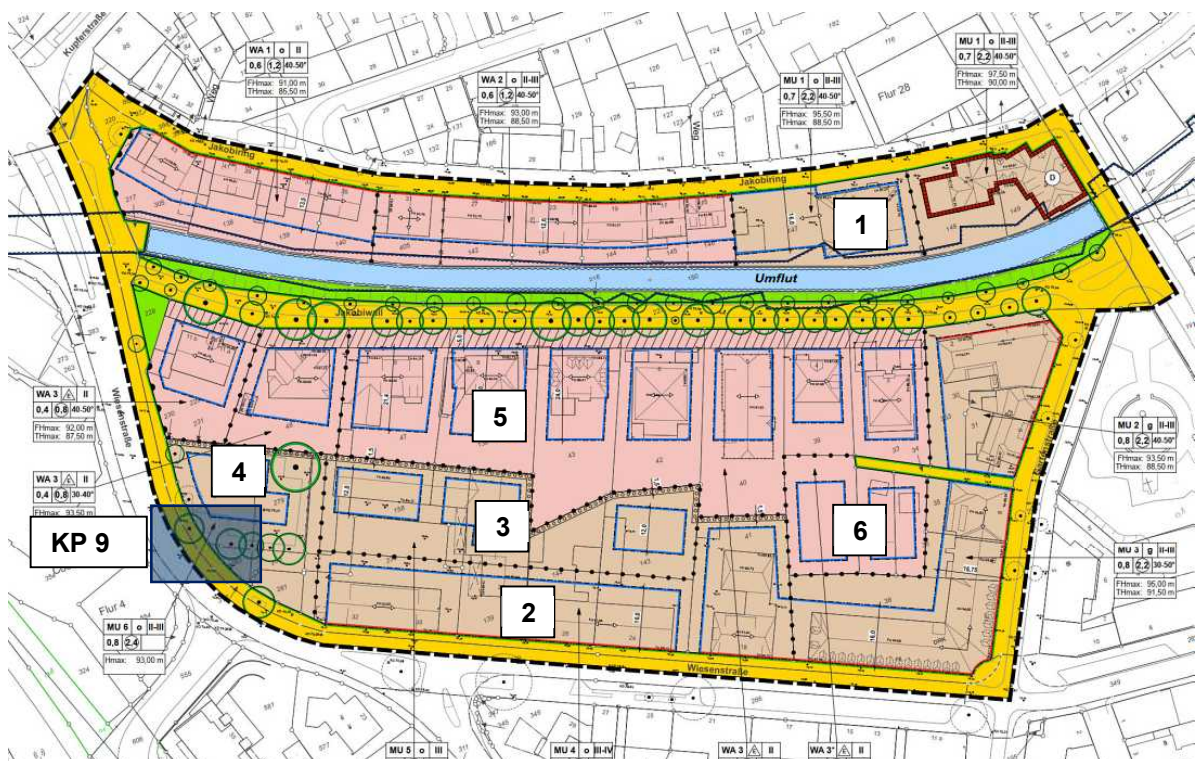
Bebauungsplan Nr. 121-3 „Coesfelder Promenade - Jakobiwall“ - Planstand 03.03.2025 [6]
